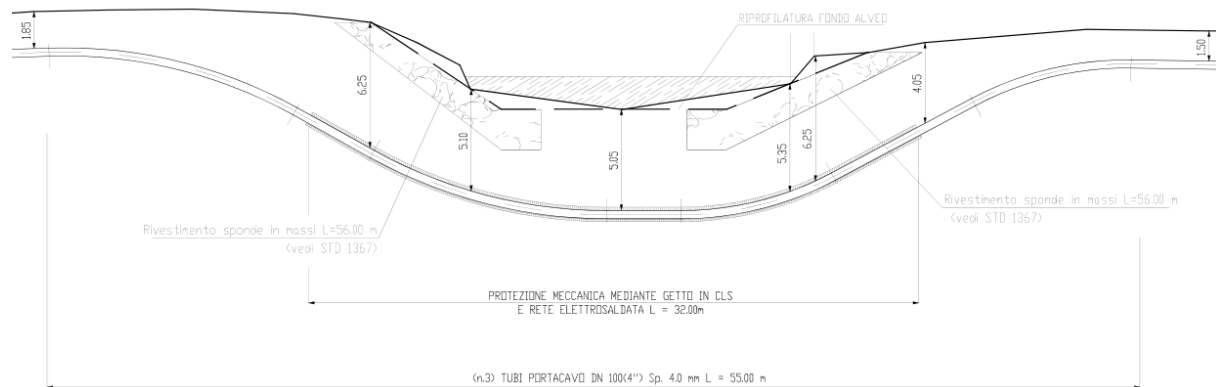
Attraversamento del fiume Velino (n. 56) - Sezione schematica di progetto l'attraversamento verrà effettuato con scavo a sezione aperta
